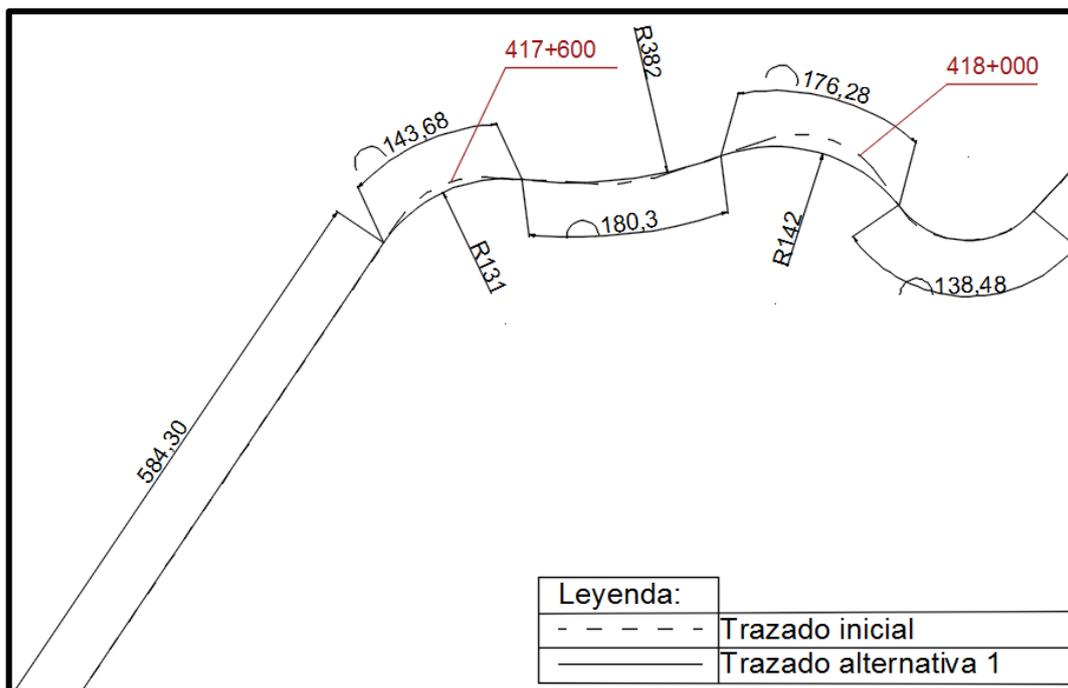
Alternativa 1 para tramo entre p.k. 417+600 y 418+000 (Medidas en metros). Fuente: Elaboración propia.
